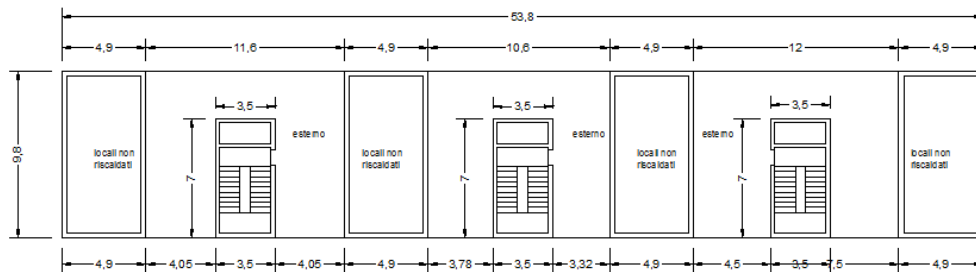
Planimetrie Edificio Tipo 2.2
